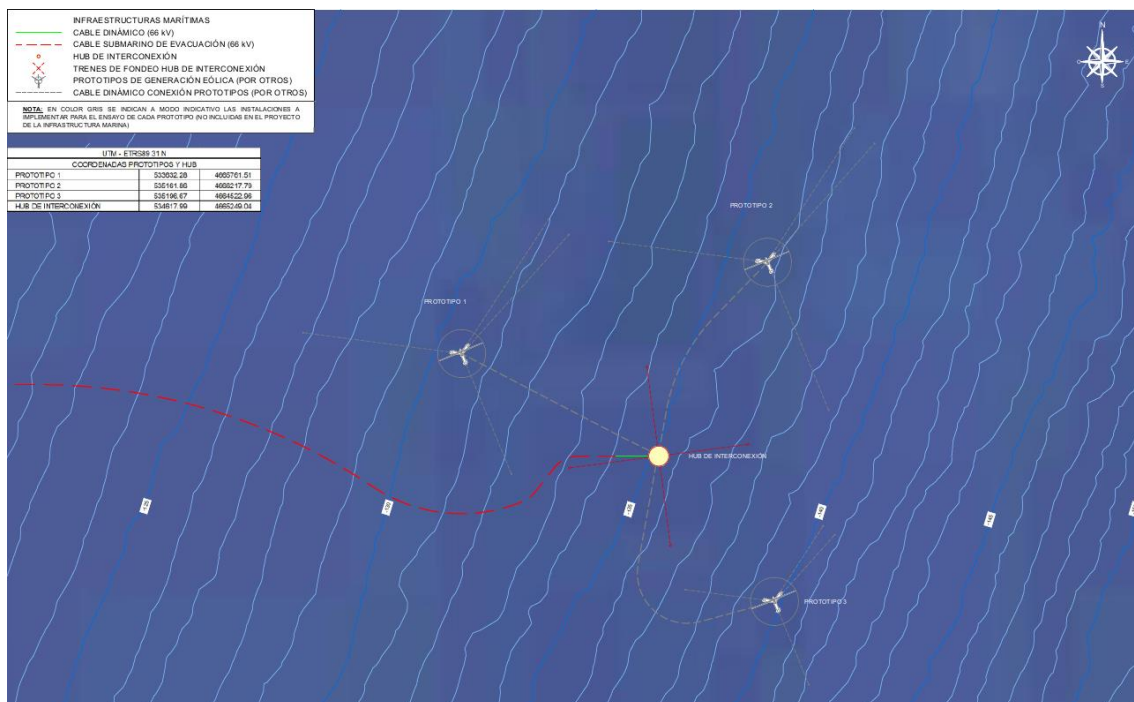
Forma en planta general de la zona de instalación de dispositivos.
